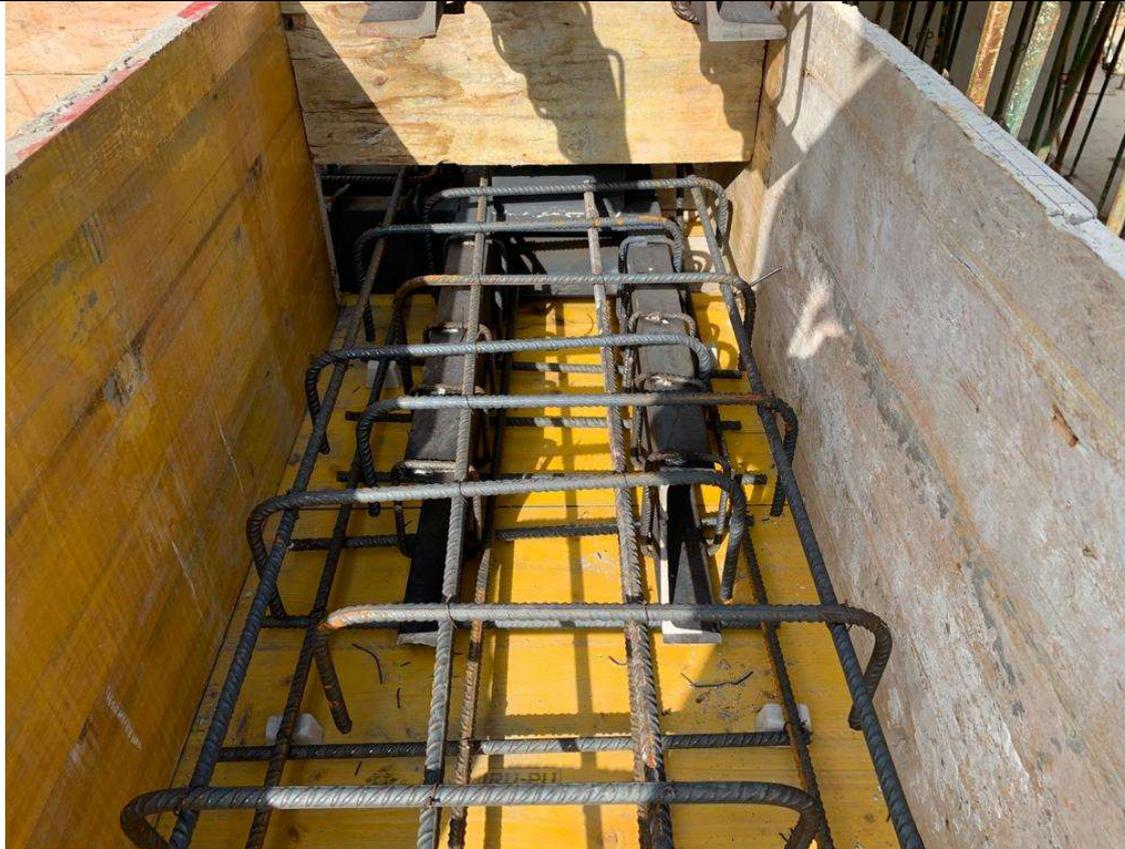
Armado cruceta pilar HEB. 2020. Fuente propia
